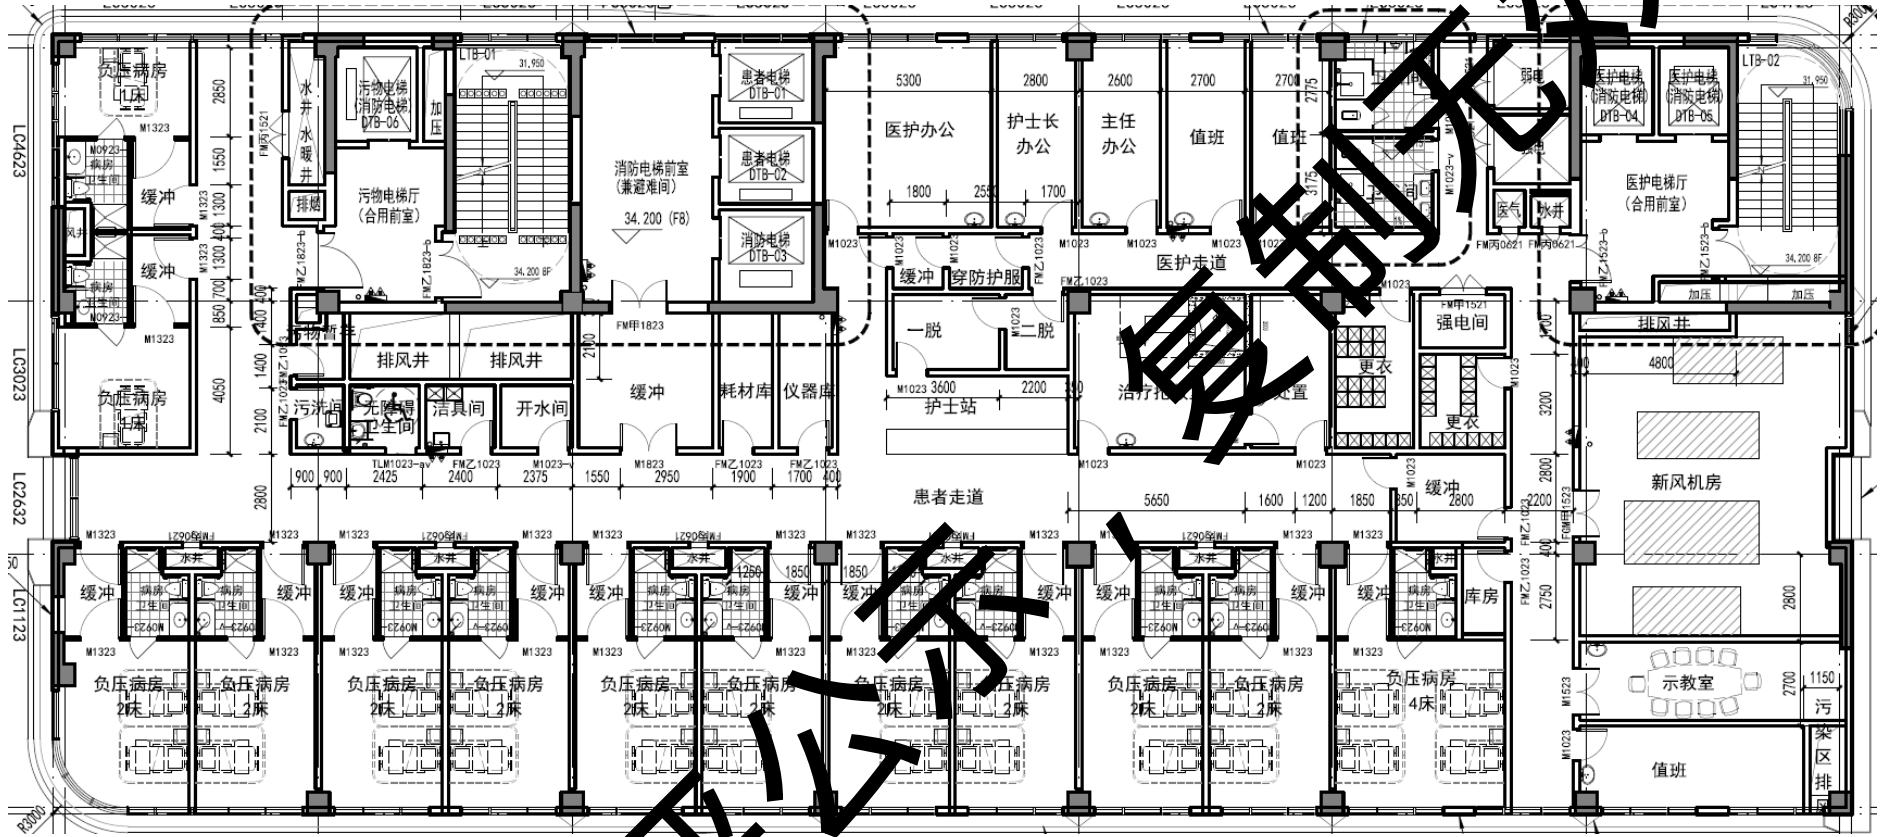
本项目新建应急中心楼 8F 平面布置图
